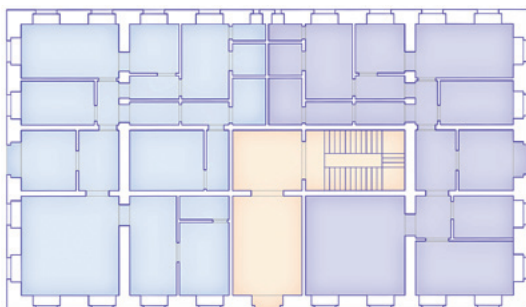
Reconstitución gráfica de la planta baja de la Casa de Oficios en 1880. Se señalan las dos viviendas de profesores en azules y la zona de alumnos en naranja. Fuente: dibujo de Jara Muñoz.
